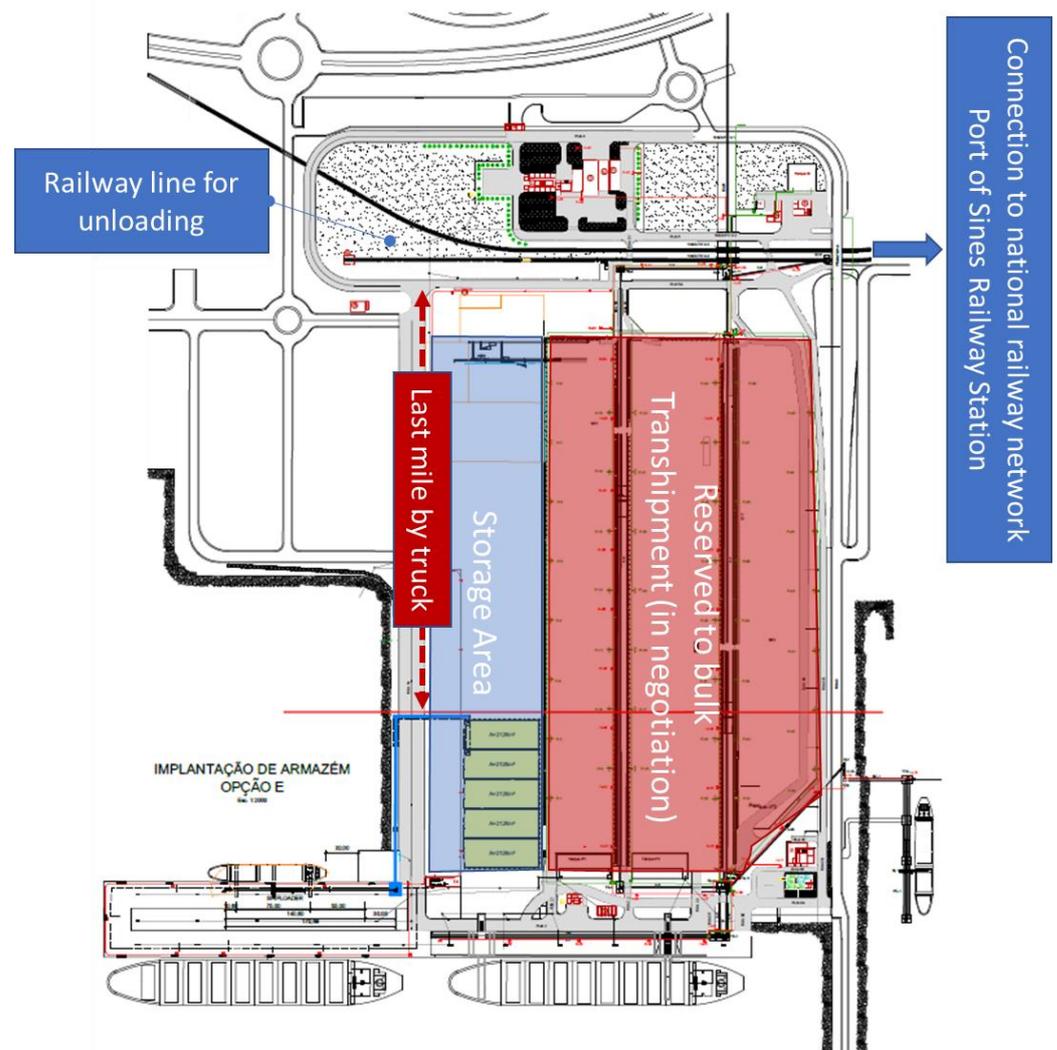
Layout Terminal Multiusos (PortSines)
